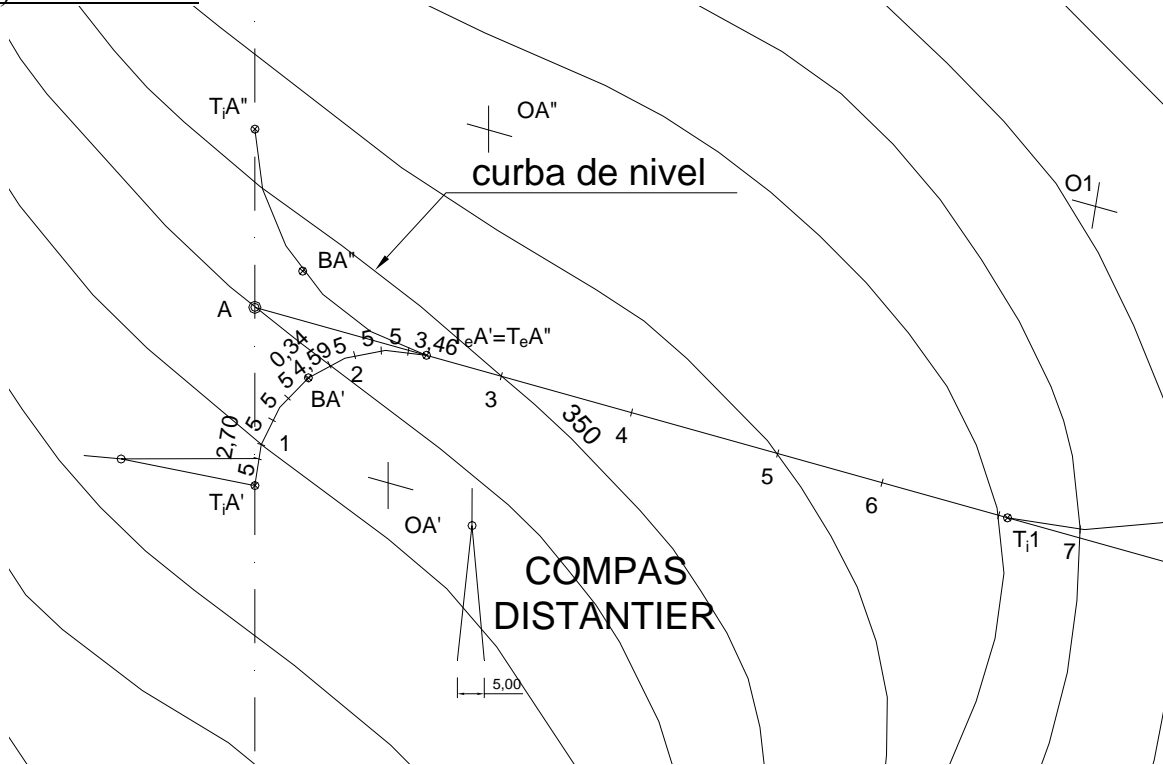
Măsurarea distanțelor între picheți în curbă
